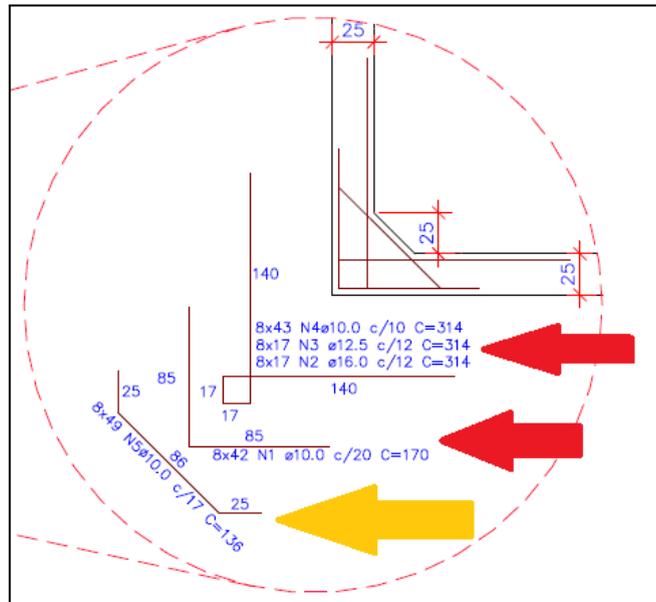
Armadura de reforço projetada para o canto de parede (mísula) [\(anexo\)](#)
